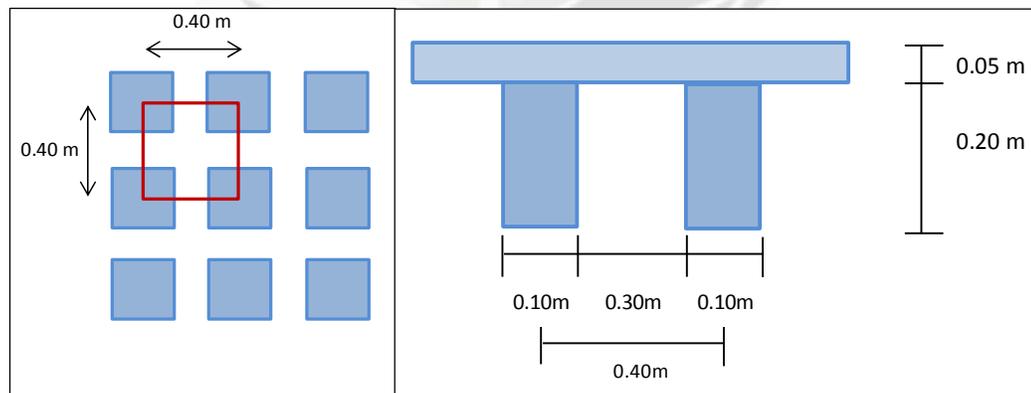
Área de Techo que Carga la Columna Analizada.
